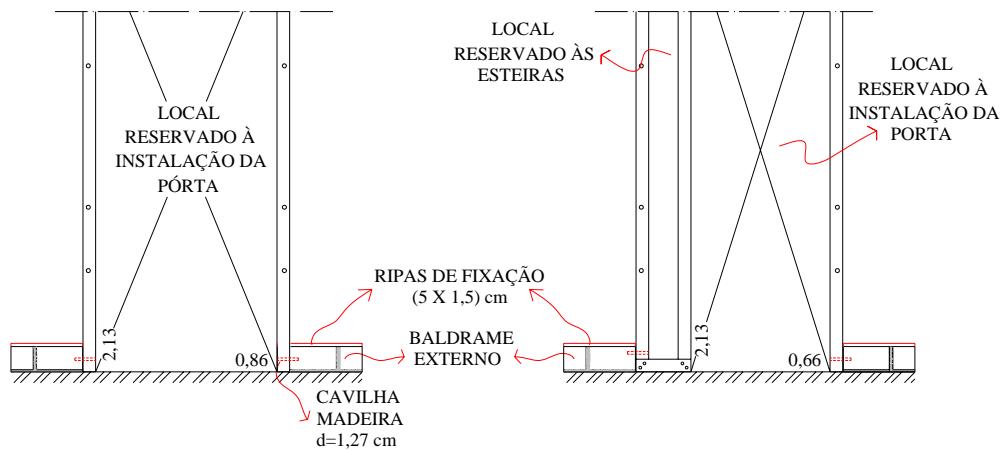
Detalhe da fixação dos painéis portas 0,86 m e 0,66 m no baldrame externo.
